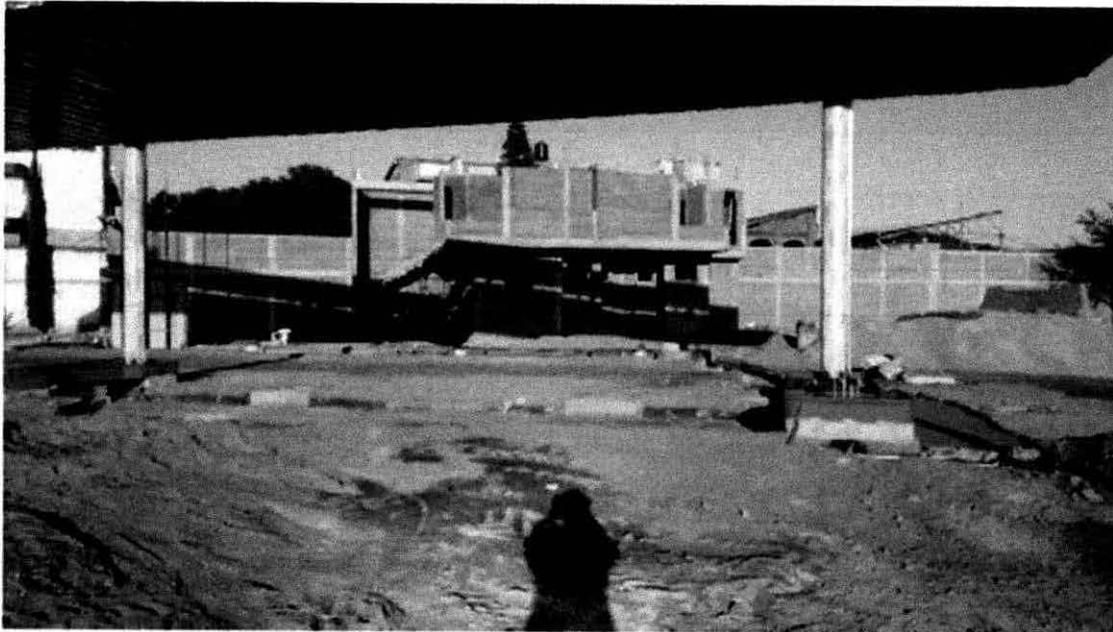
Vista general de la Gasolinera, se observa el tapado de tubos conduit.
